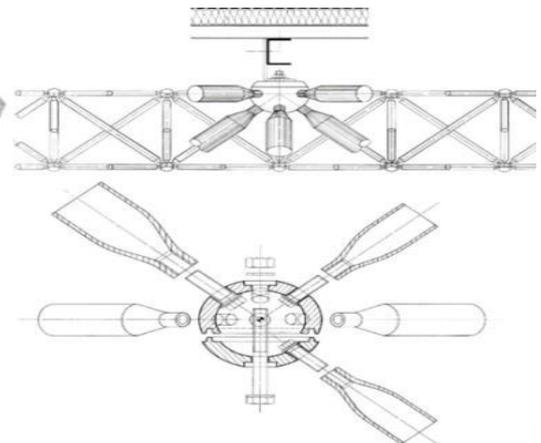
les poutres tridimensionnelles et la rotule de fixation
